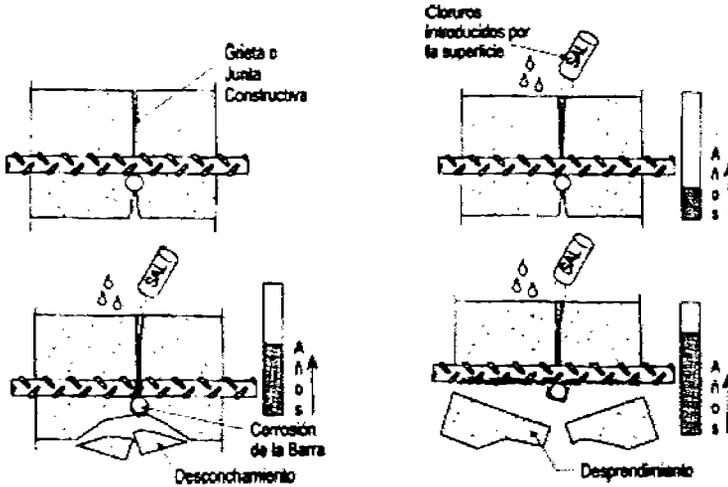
EFECTO DE GRIETAS O JUNTAS EN LA CORROSIÓN DEL ACERO.
